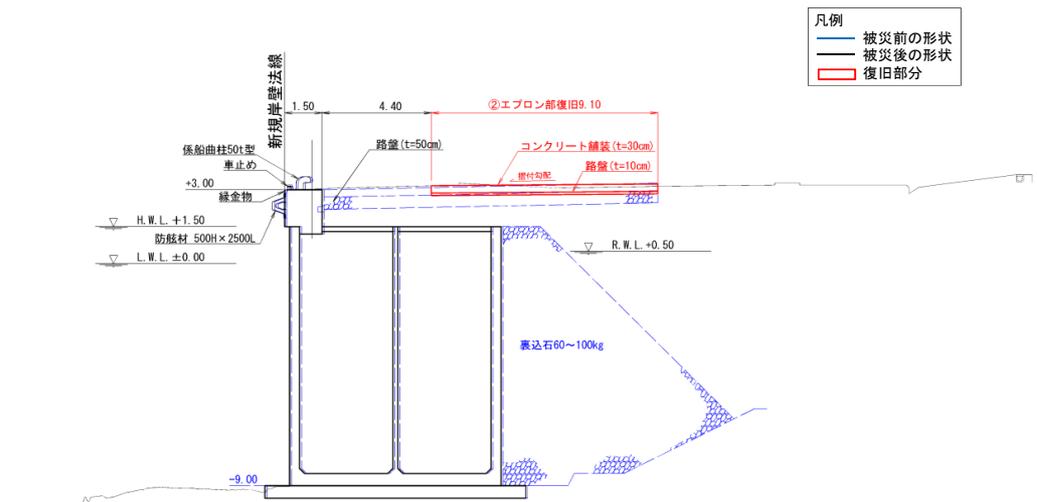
No.5 日立港区_第2埠頭地区 2-B岸壁 (-9m) の断面図 (復旧後)
